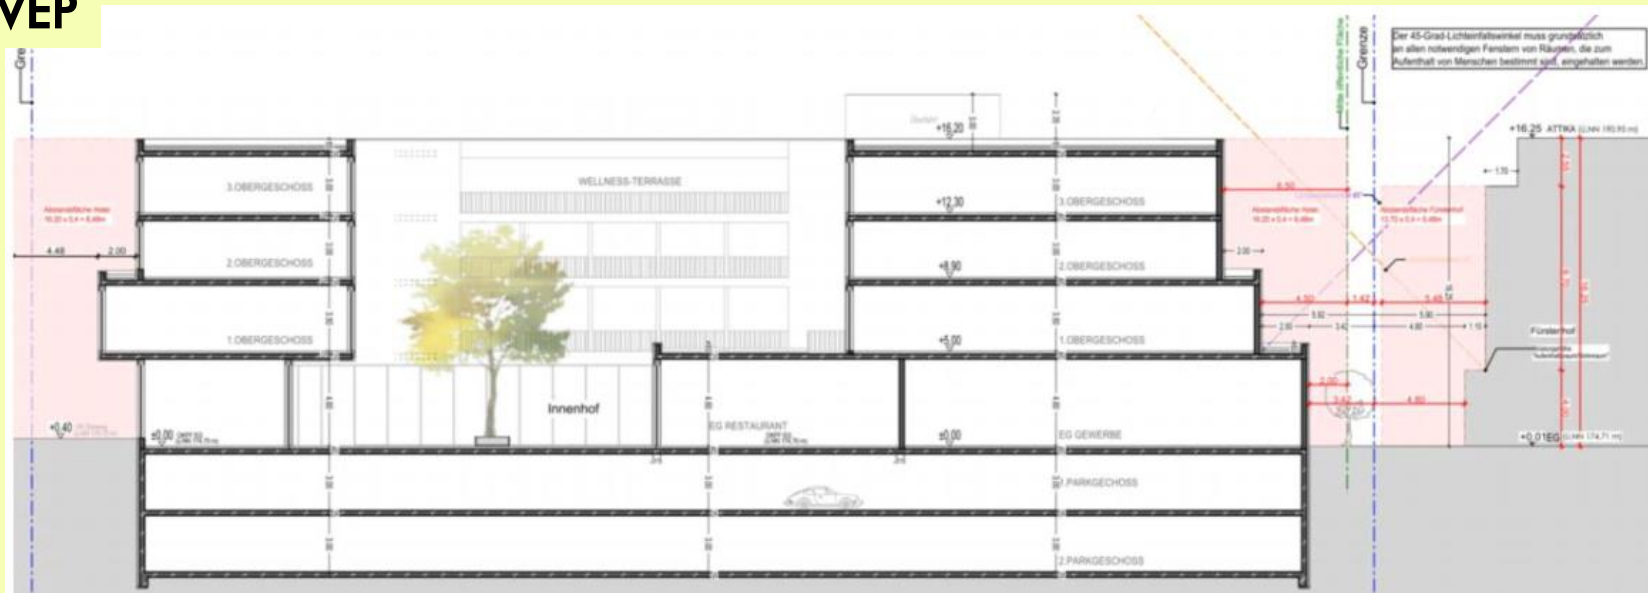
Gebäudeschnitt (Stand Jan. 2021)
